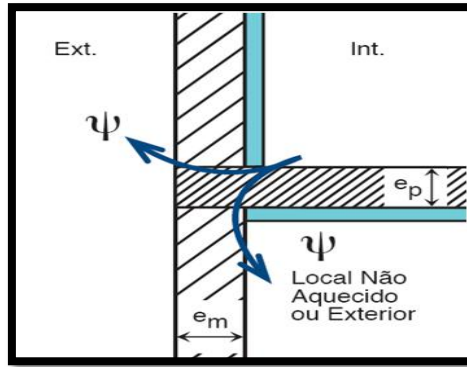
Ligação da fachada com pavimentos sobre Locais não Aquecidos; fonte: RCCTE (2006)
